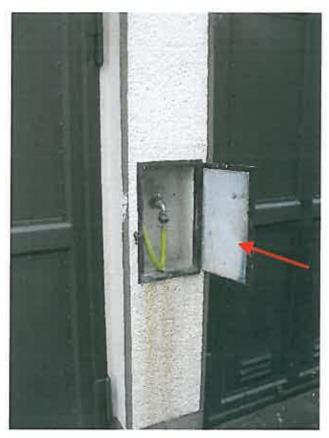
Wasseranschlusskasten (Tür mit asbesthaltiger Leichtbauplatte, siehe Probe P 2)
